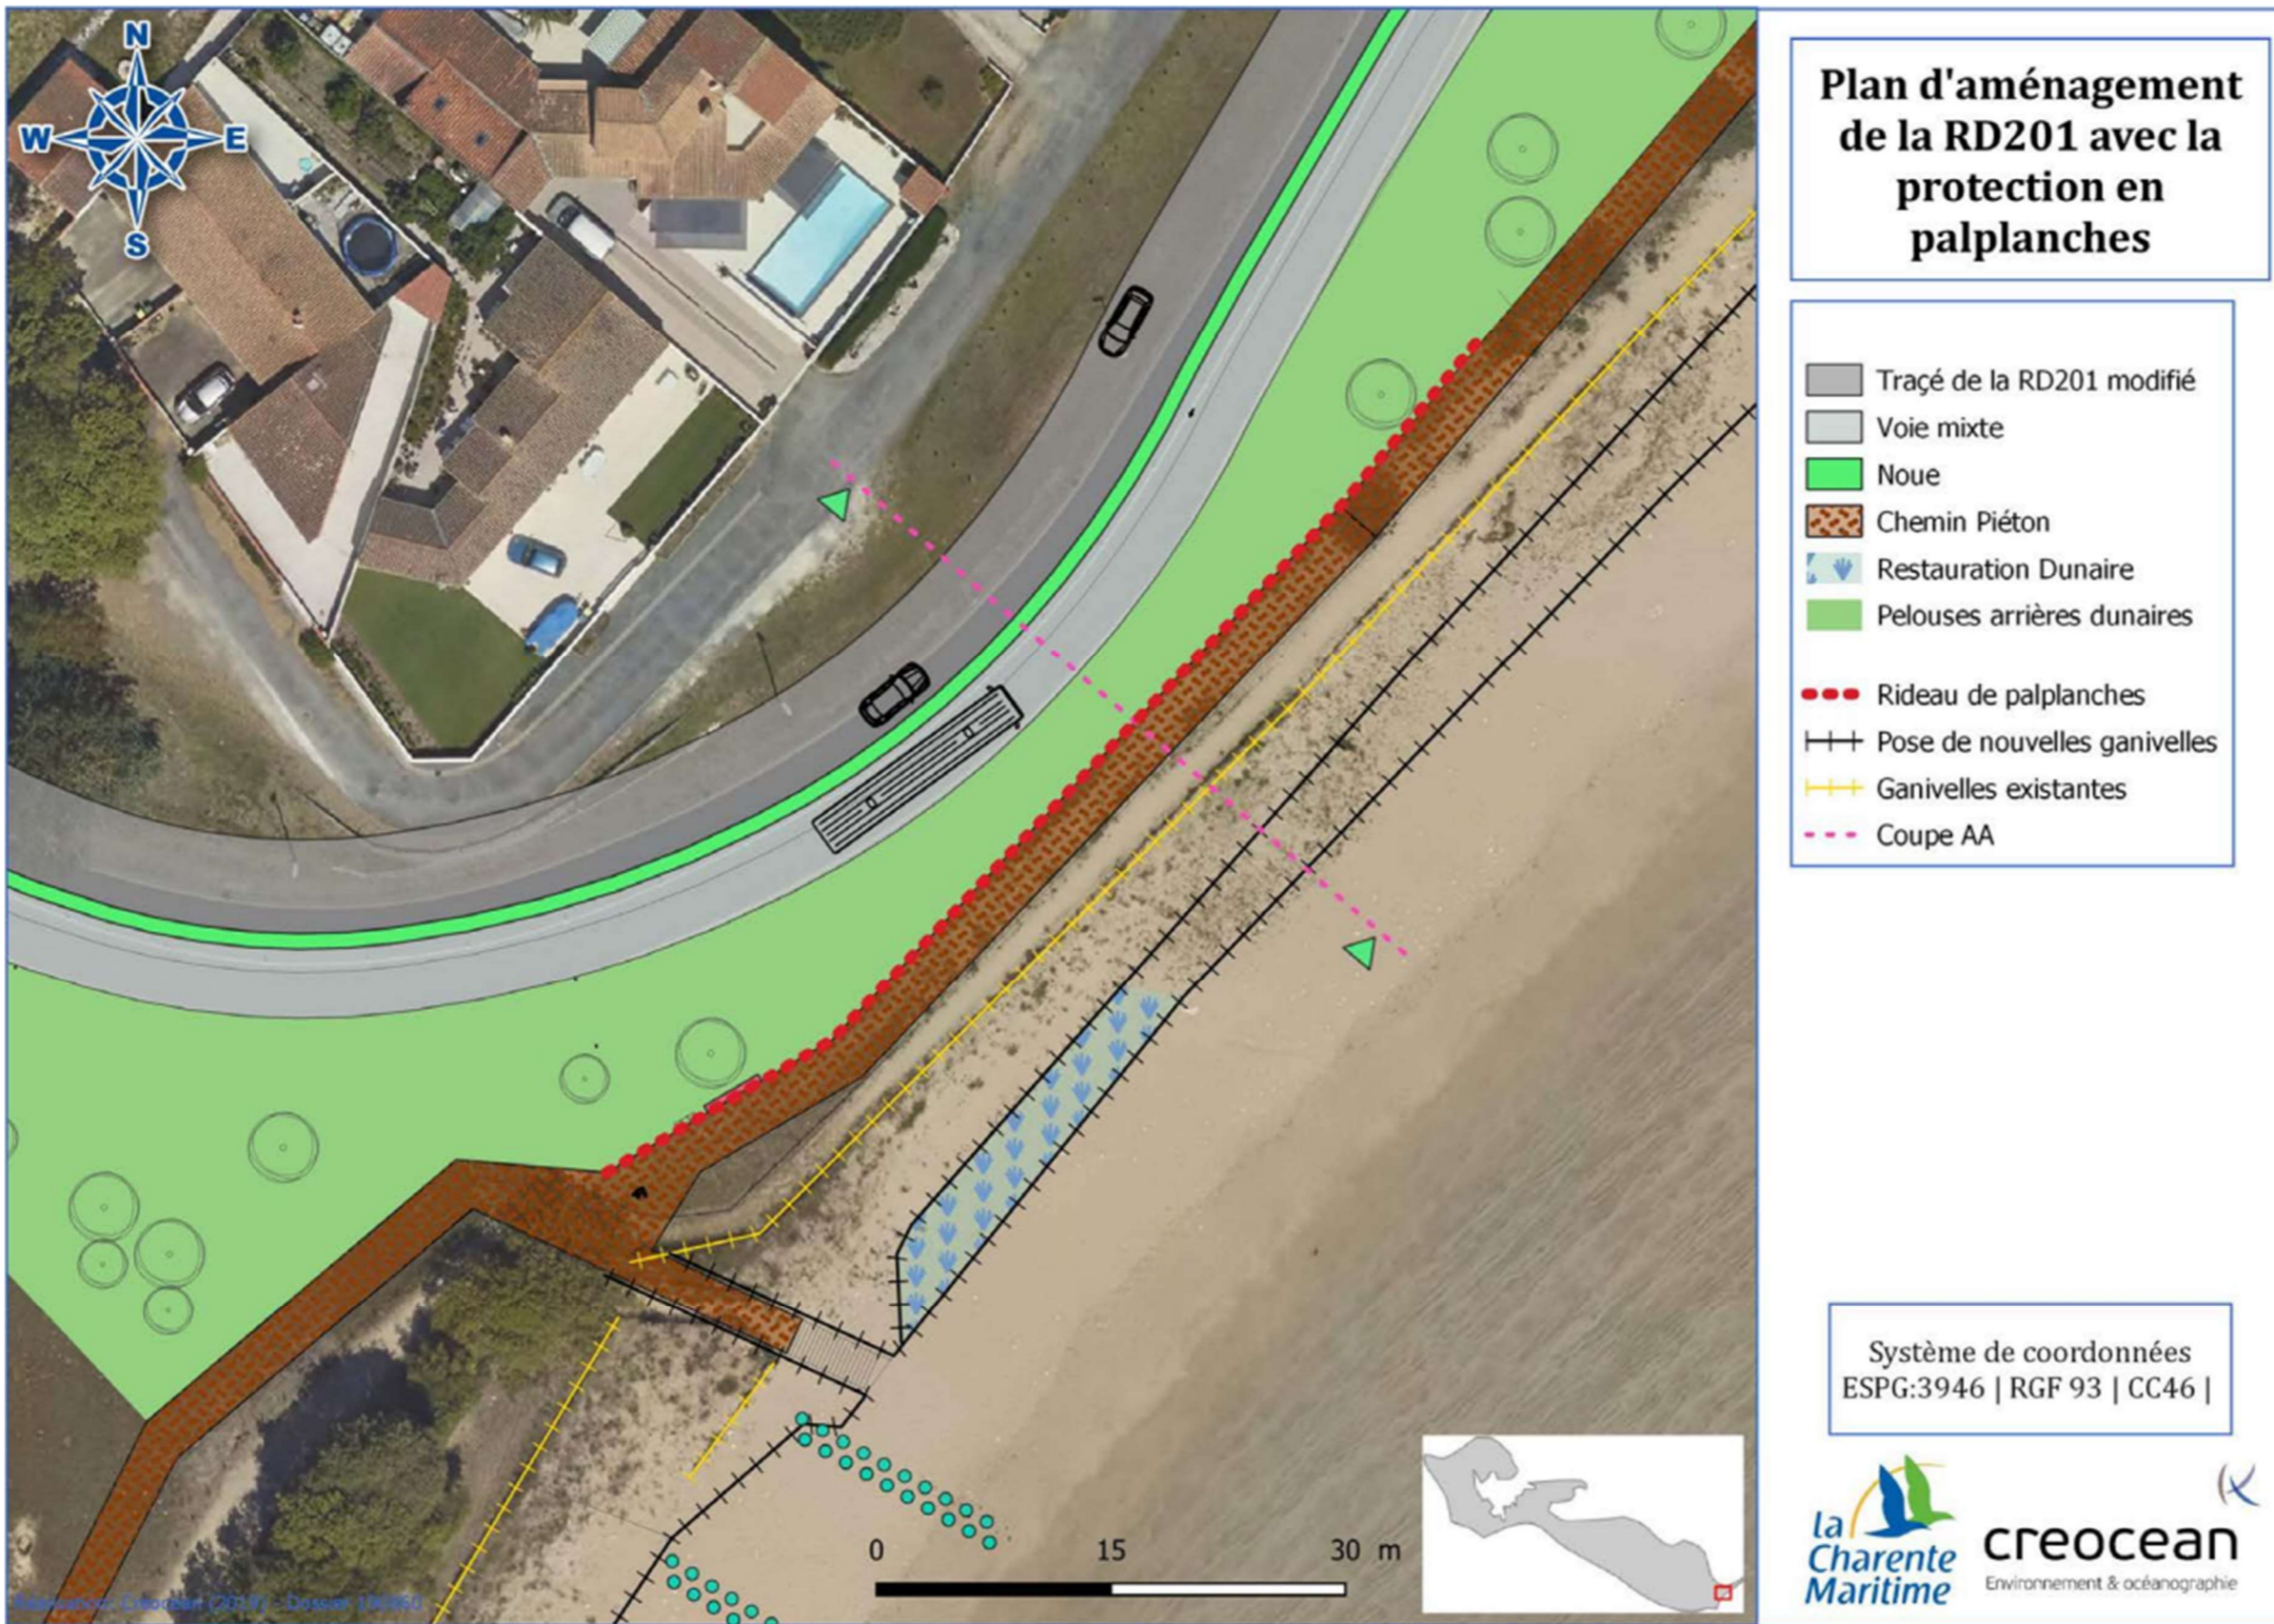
Plan d'aménagement – confortement RD201 avec le scenario 2 : protection en palplanches – du projet « 3. Système de protection de côte du virage du défend »
